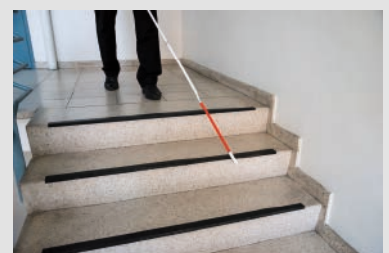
Deutlich markierte Stufenvorderkanten helfen sehbehinderten Menschen sowie Menschen mit eingeschränkter Orientierung
